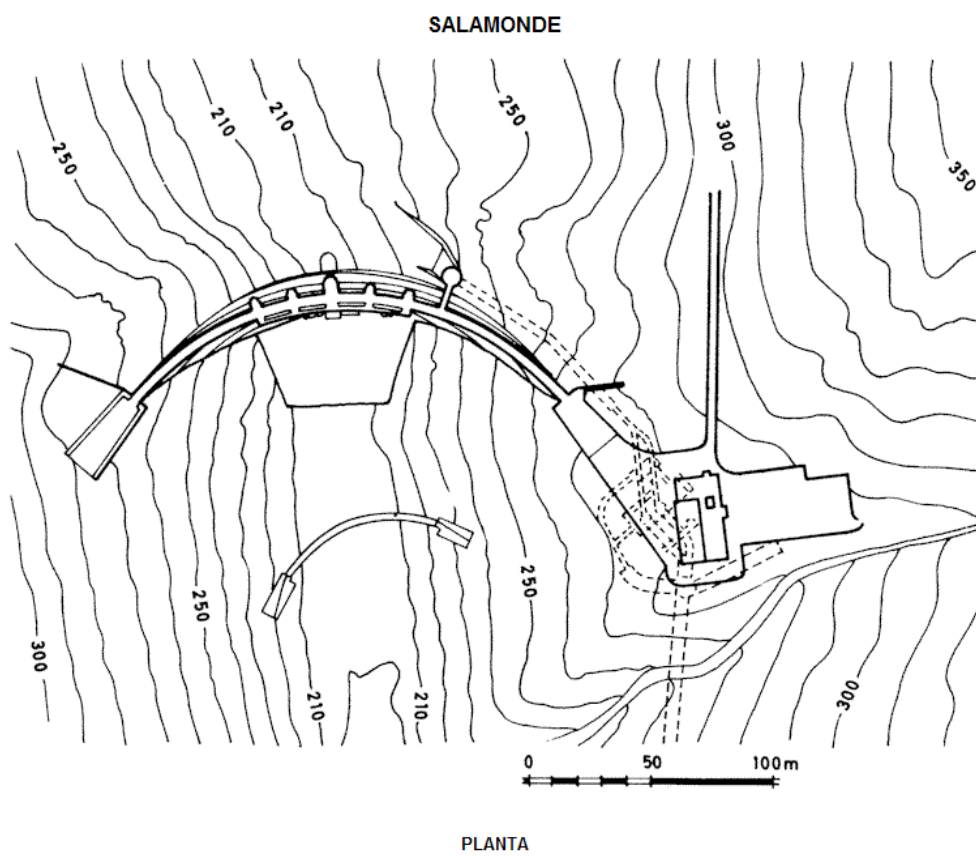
Barragem de Salomonde – Planta [4]
